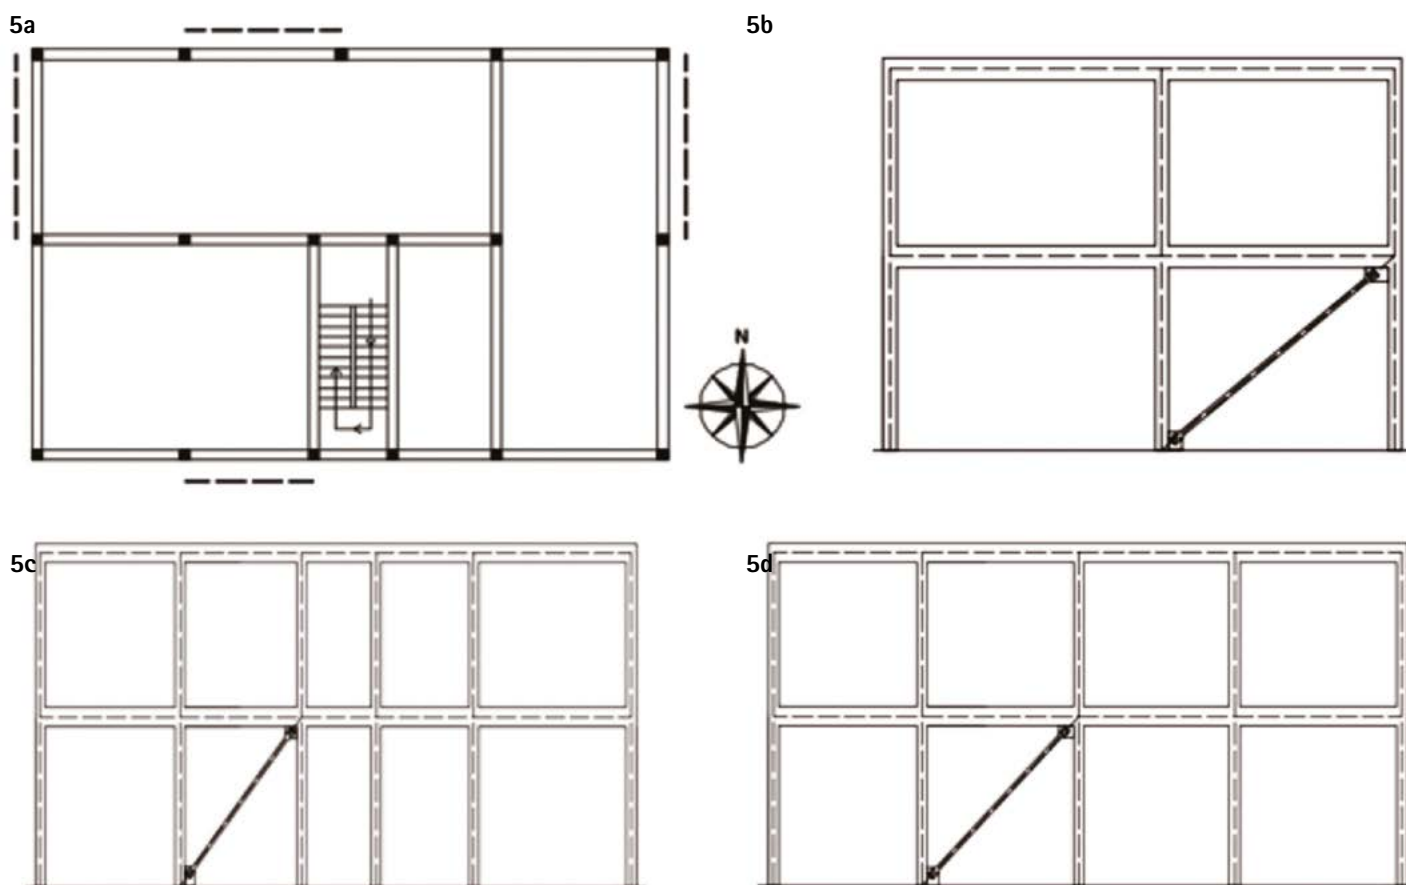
a) vista in pianta del posizionamento dei BRB; b) posizionamento dei BRB nei lati est ed ovest; c) posizionamento dei BRB nel lato sud; d) posizionamento dei BRB nel lato nord.
